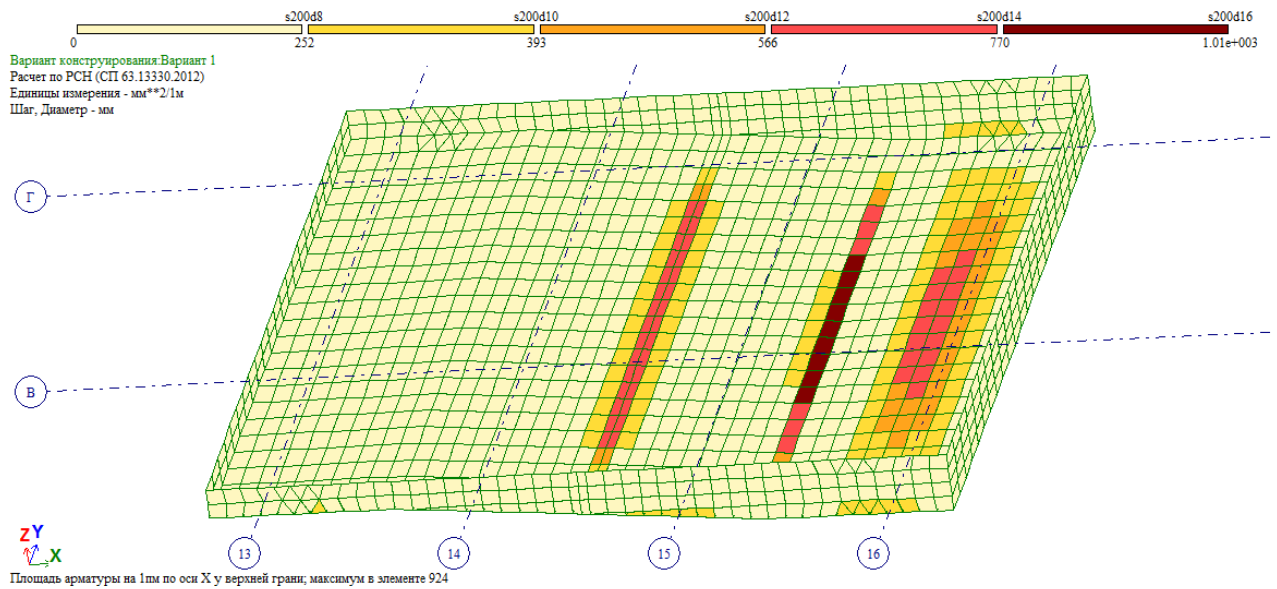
Продольная арматура верхней зоны вдоль буквенных осей
